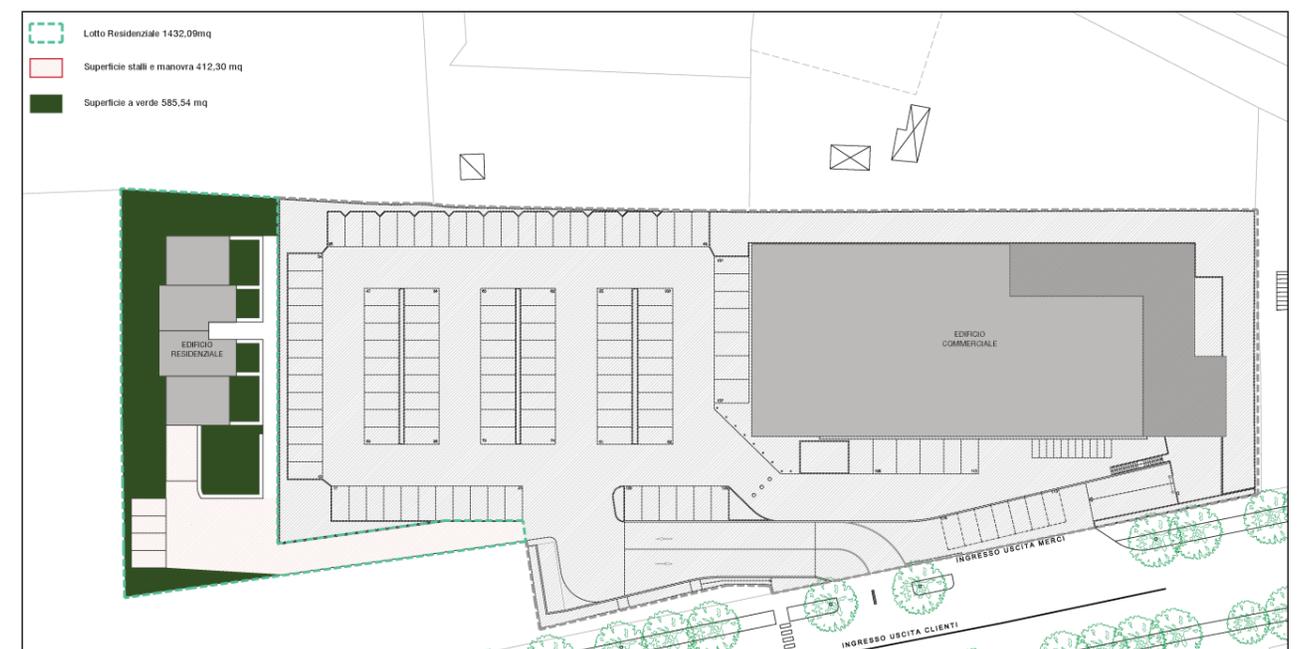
Planimetria indicativa del Piano Attuativo - Lotto Residenziale
